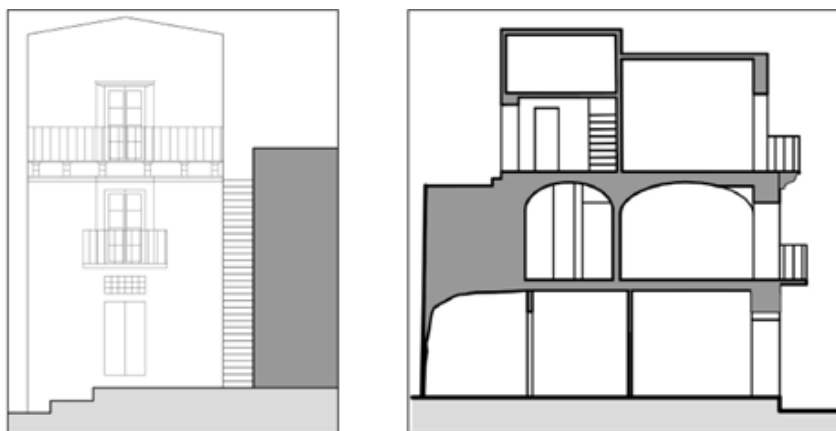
prospetto est dell'edificio e sezione dell'edificio
